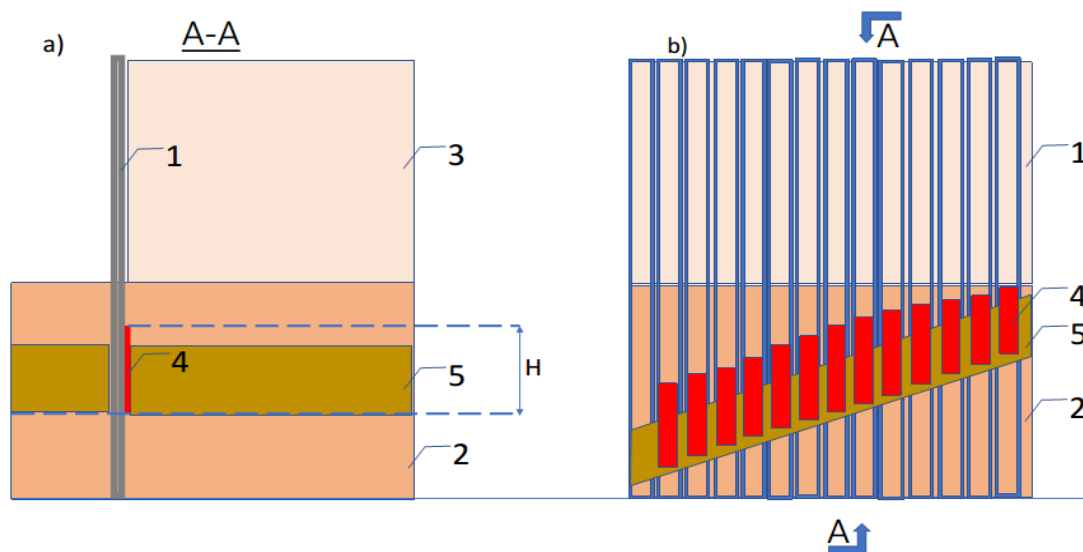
Схема застосування накладок для шпунтових паль з неоднорідною ґрунтовою основою: а – поперечний переріз; б – вид ззаду на стіну шпунтової palі; 1 – шпунтова стінка; 2, 5 – шари неоднорідної ґрунтової основи; 3 – засипка ґрунту; 4 – накладки.
